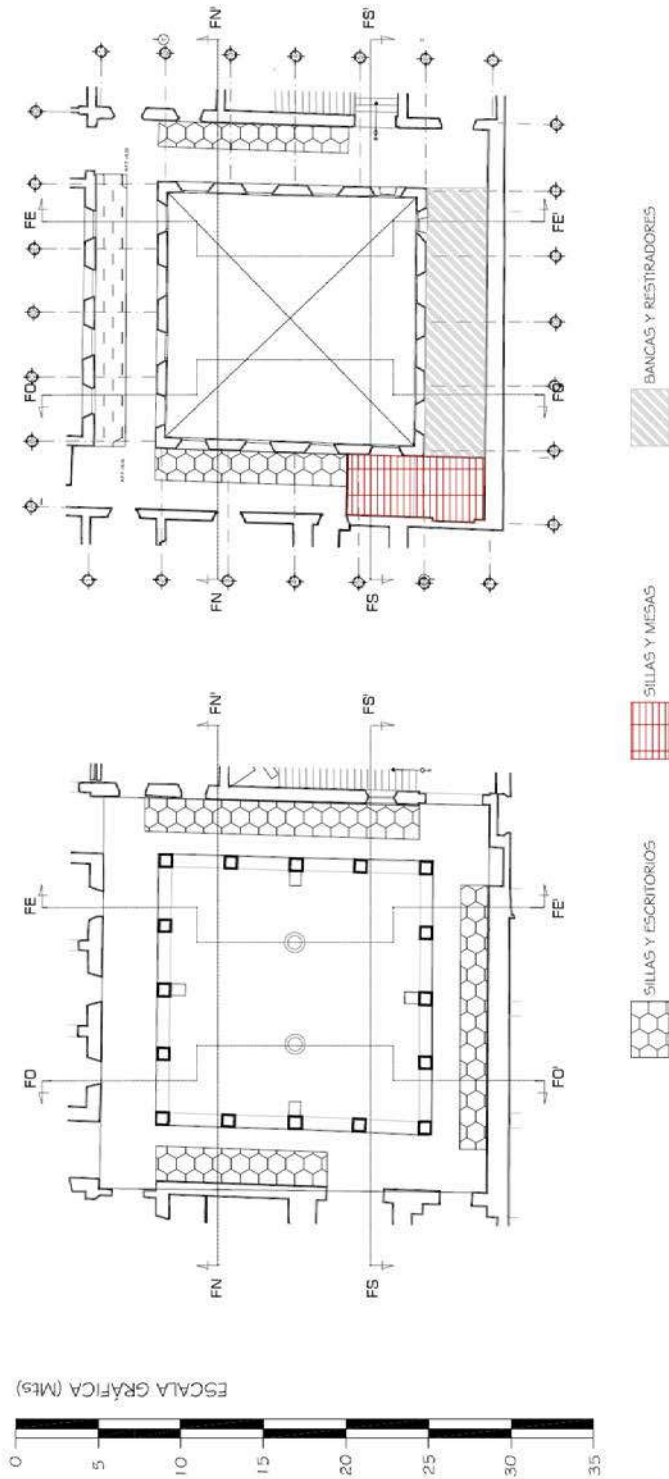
Distribución de las áreas de trabajo en el claustro bajo.
